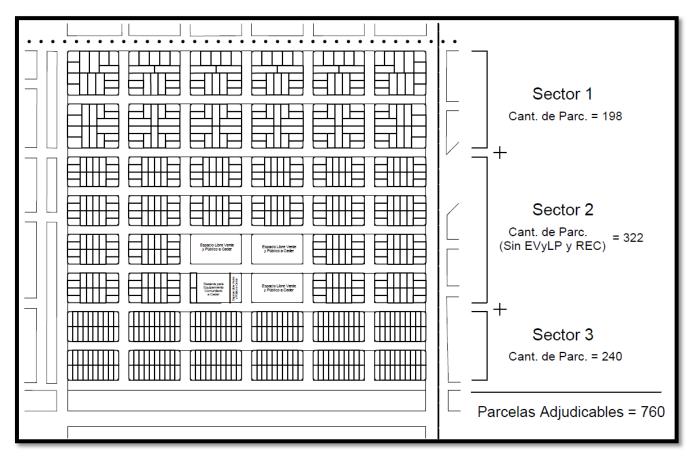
Parcelas adjudicables recalculadas) (Ley 14.449) Elaboración: Propia (AutoCAD)
